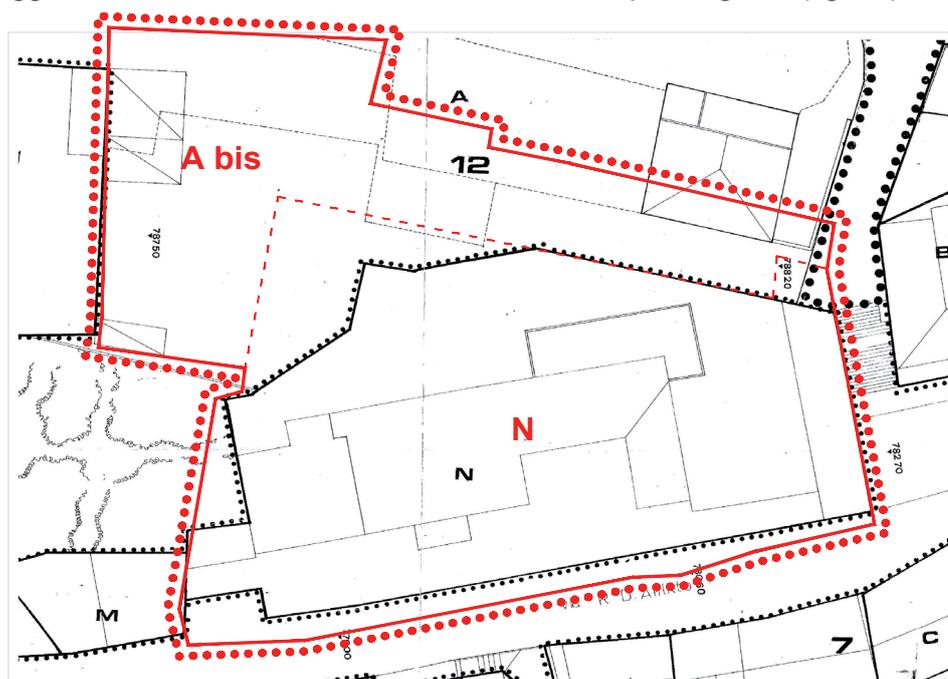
Stralcio del Piano di Recupero vigente con sovrapposizione delle perimetrazioni aggiornate alla planimetria catastale (cfr. fig.3, p.5) e al rilievo dello stato effettivo dei luoghi e l'introduzione della nuova unità minima d'intervento
